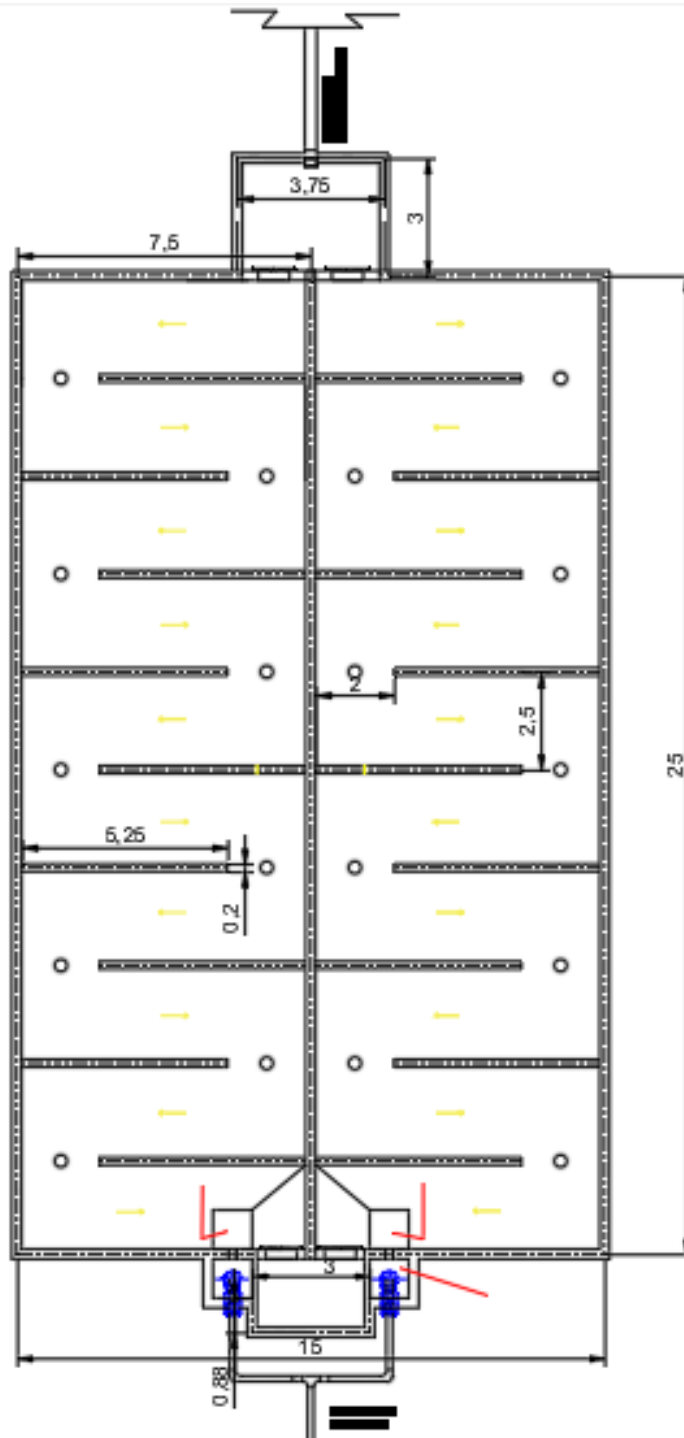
b: Esquema interior planta cisterna
